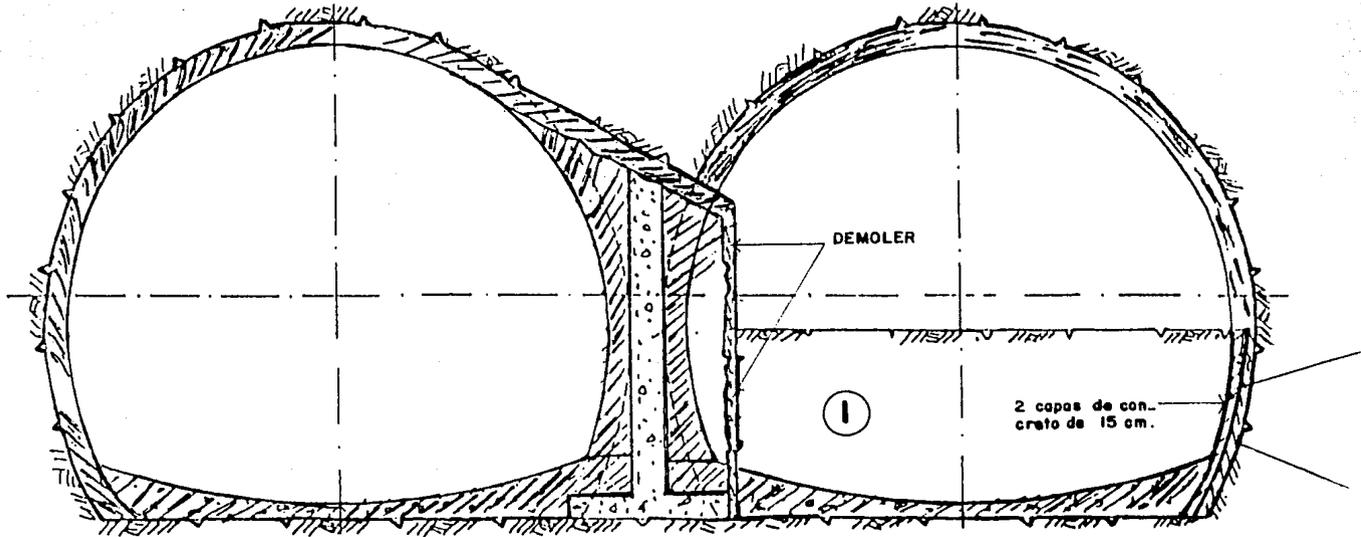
EXCAVACION DE BANQUEO 2a. SECCION
